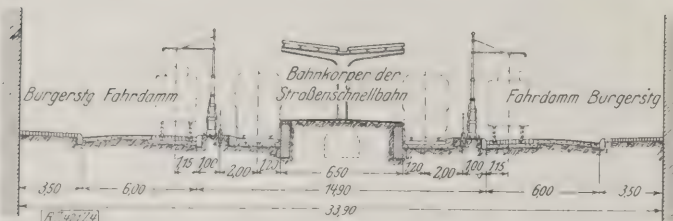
Ausfallstraße mit Bahnhof der Straßenschnellbahn.
